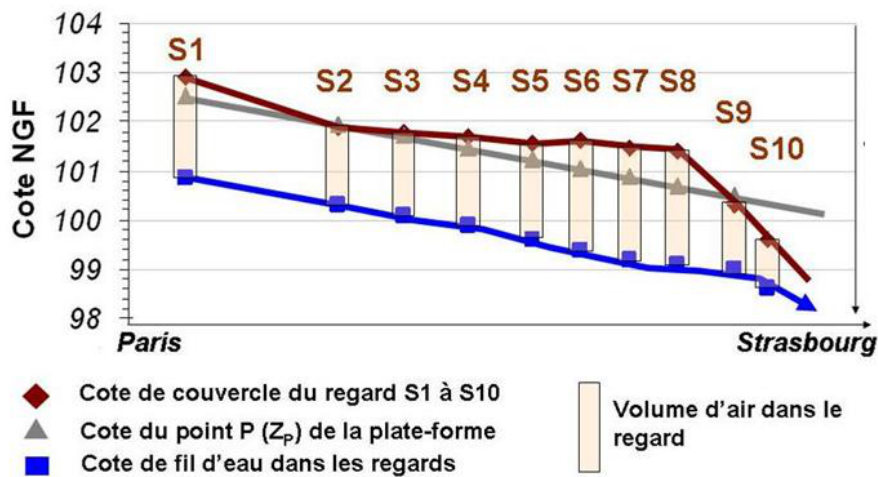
Profil en long du collecteur drainant -Chauconin (77)- 04/2014
